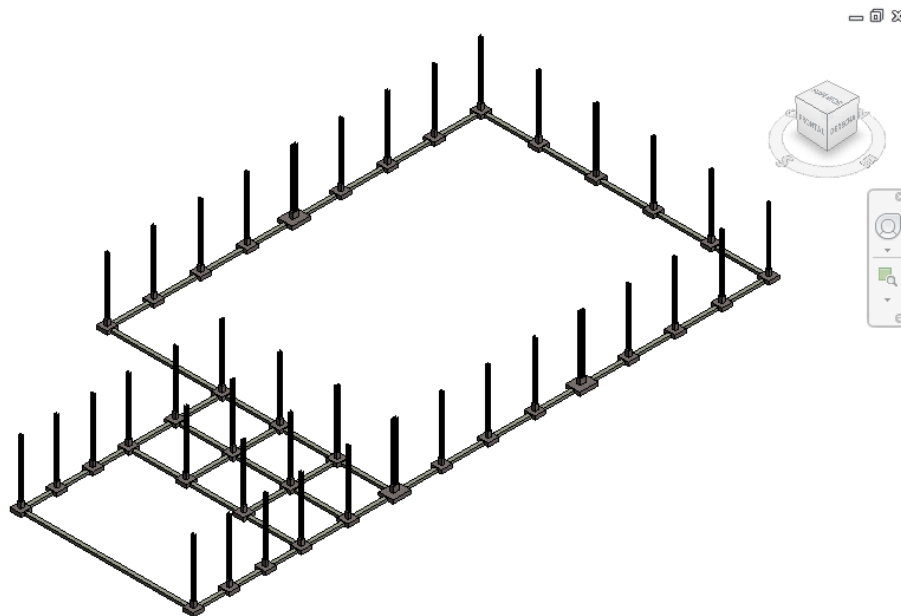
Definición completa de la cimentación estructural. Fuente: elaboración propia
